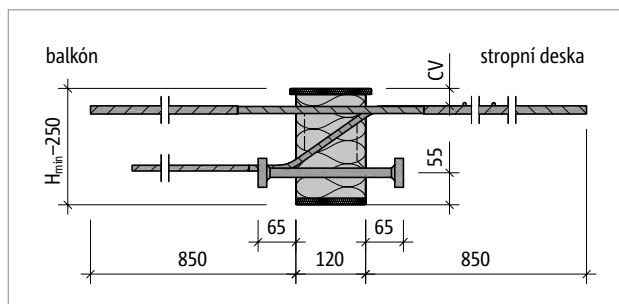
Schöck Isokorb® XT typ KL-M5-VV1: Půdorys prvku
